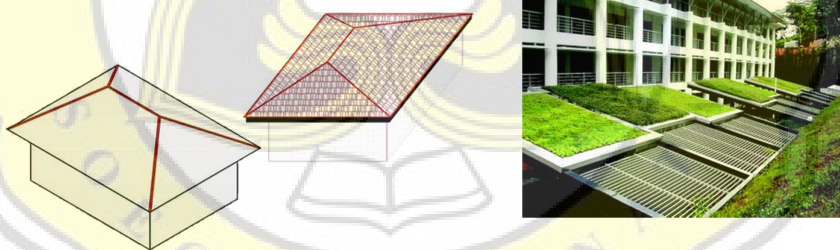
10 Penerapan Bentuk Bangunan terhadap Pendekatan Desain
